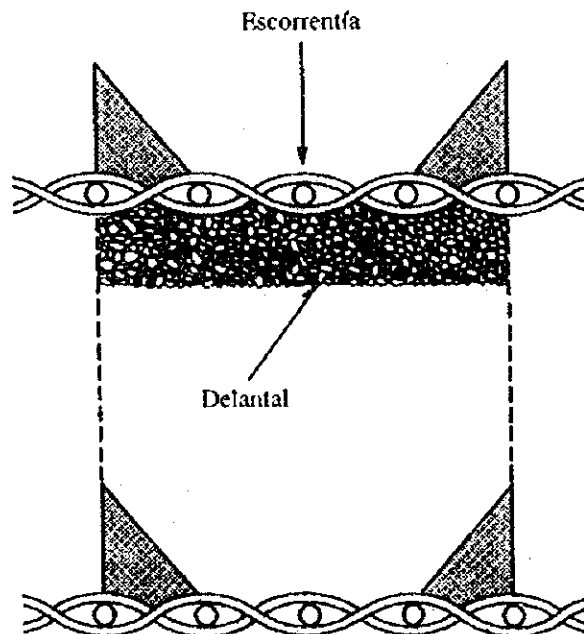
Planta de la Presa de Ramas para el Control de Azolves
